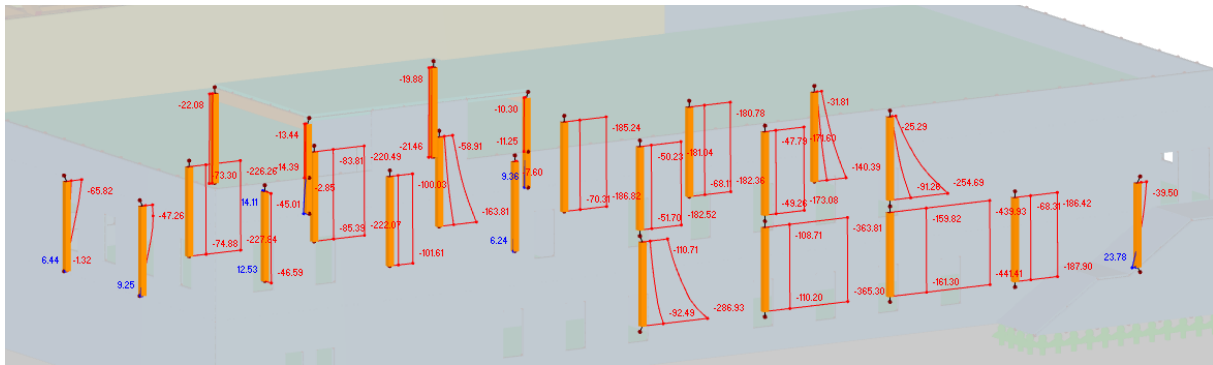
Vigas de atado del sótano. Momentos torsores.
